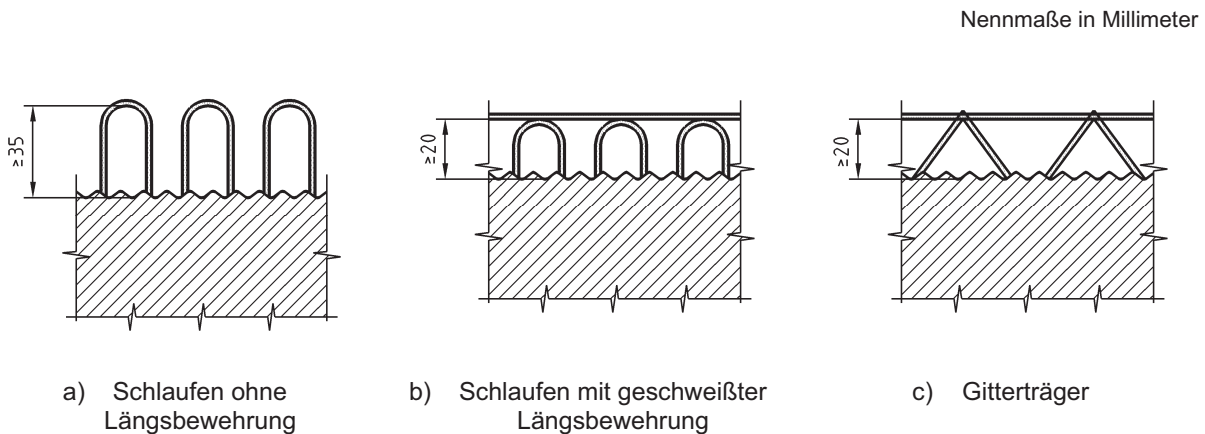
Anordnung der Verbundbewehrung für eine gute Betoneinbringung und -verdichtung
